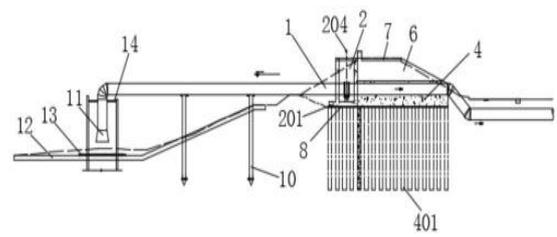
图 1 沿管道方面纵剖面图 (AA 剖面图)
